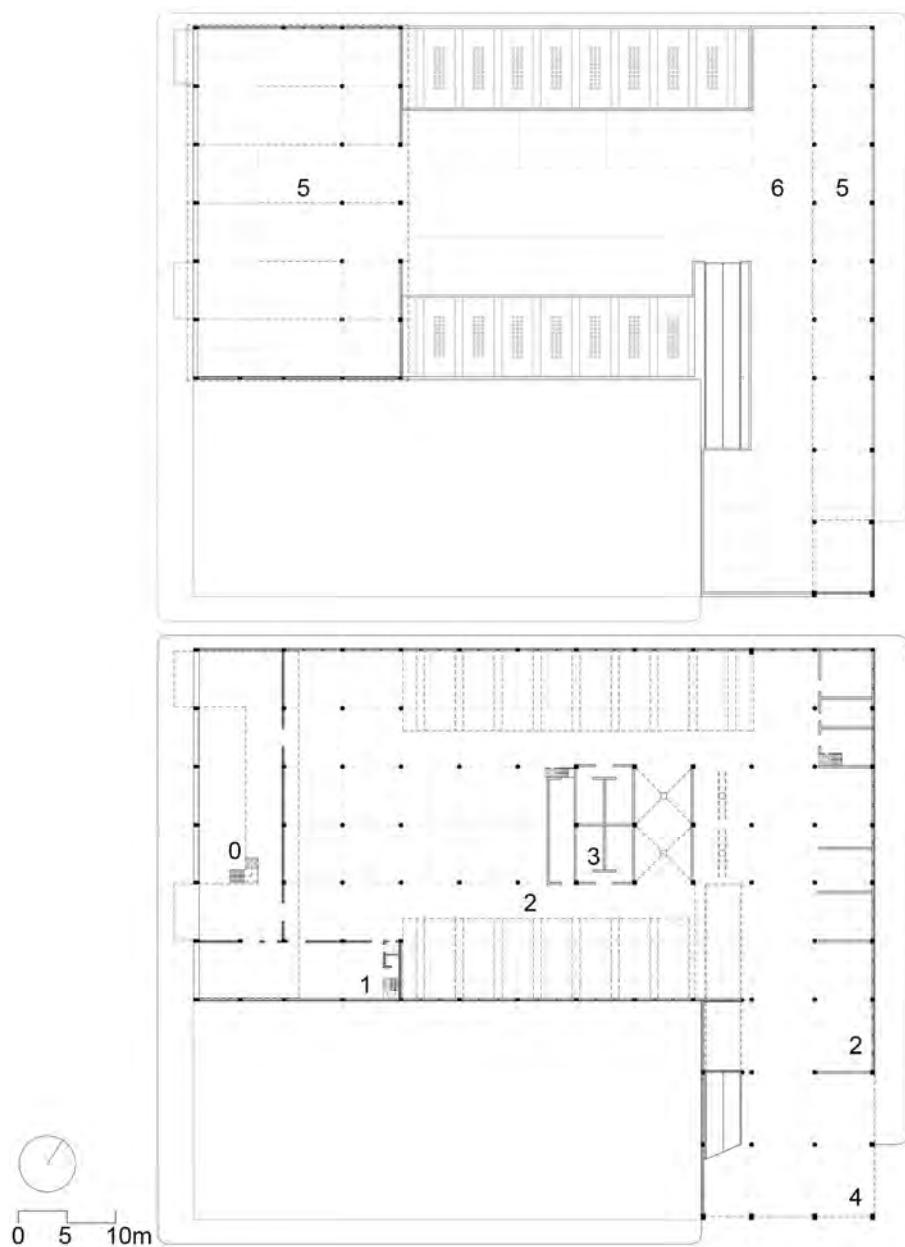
Volkswagen, dall'alto verso il basso: planimetria piano copertura e piano terra. 0. Sala esposizione; 1. Vendita pezzi di ricambio; 2. Officina; 3. Servizio; 4. Ingresso auto-veicoli; 5. Esposizione coperta; 6. Esposizione all'aperto. Fonte: elaborazione dell'autrice.
